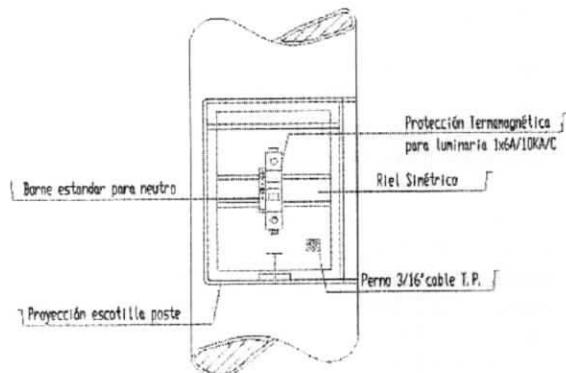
Detalle Protección Luminarias en Postes Metálicos
